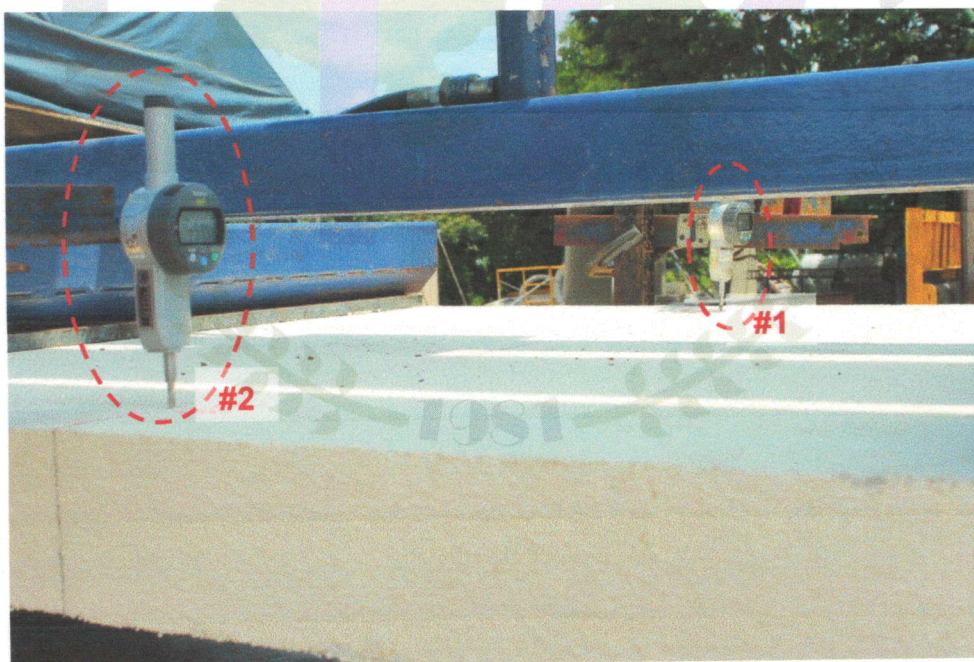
Deformómetros #1 y #2 en espécimen FLEX - 1,23 m - 02.
